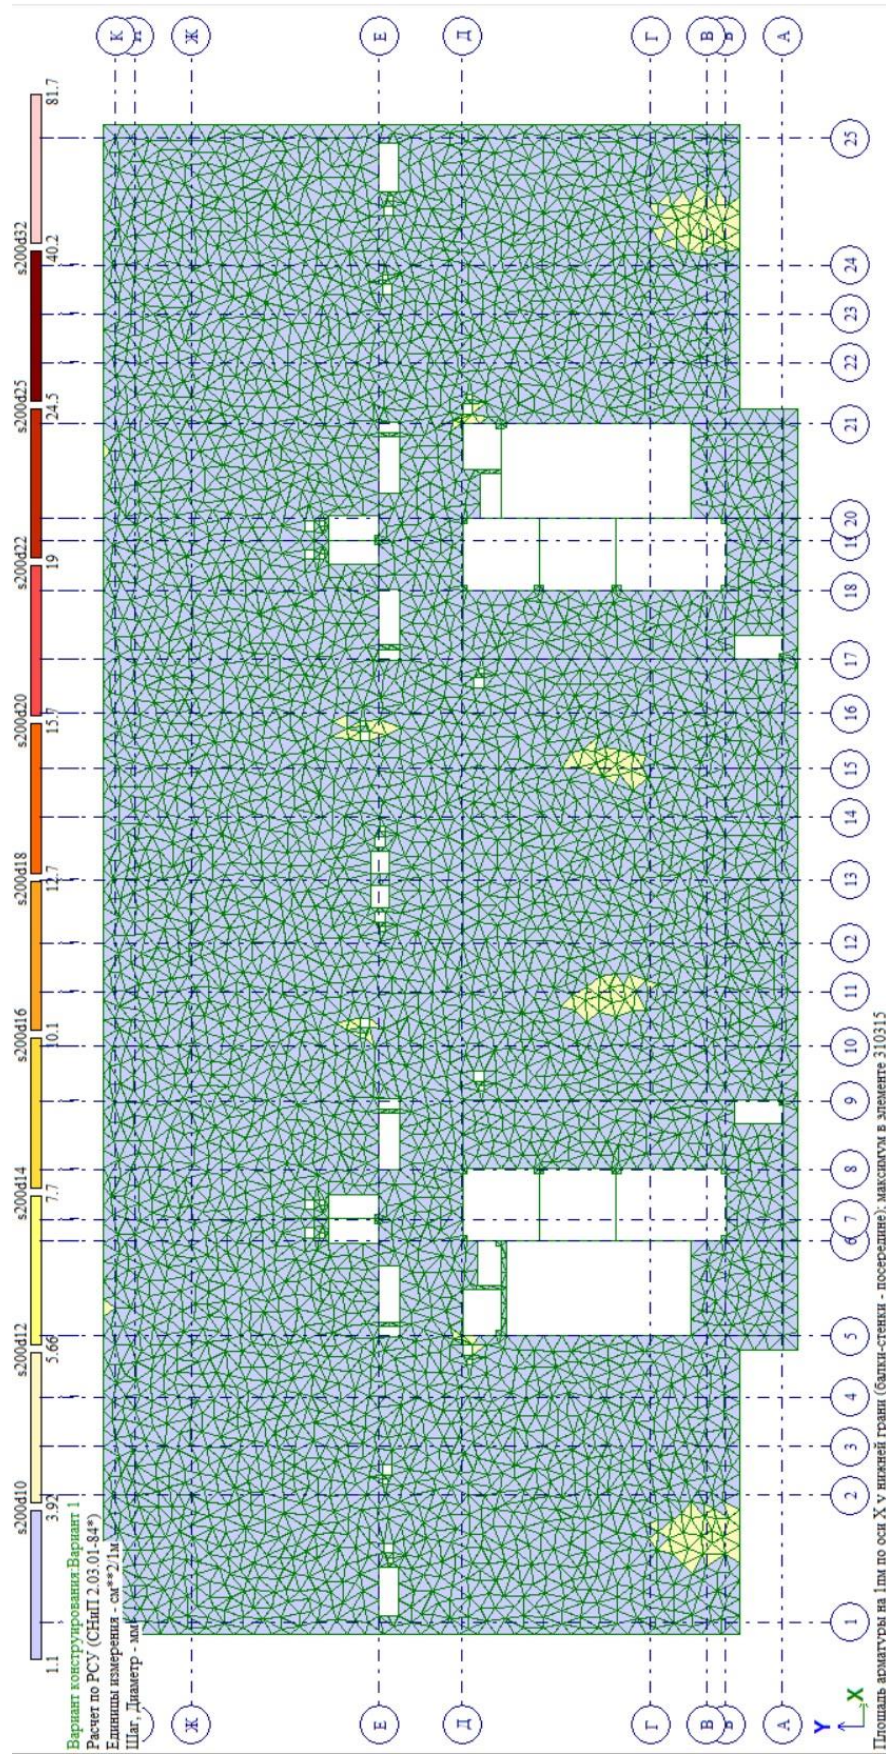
Нижнее армирование плиты вдоль оси X
